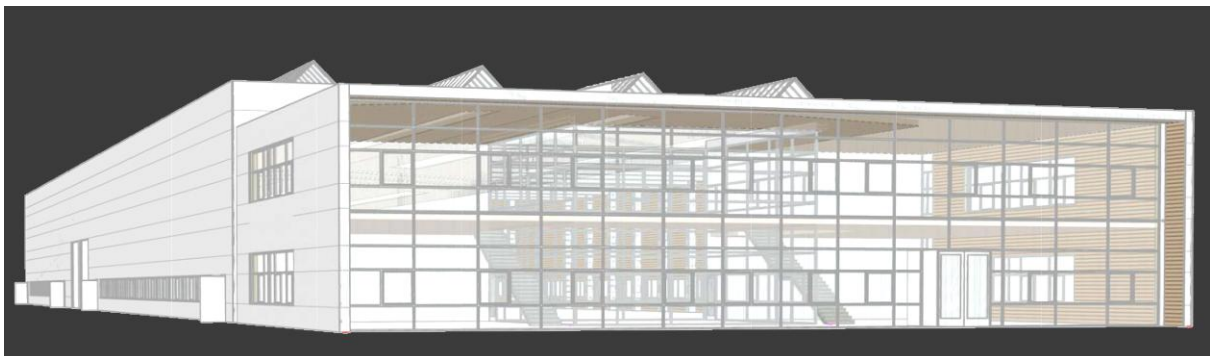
Beispiel einer eco²building Halle mit Kopfbau
